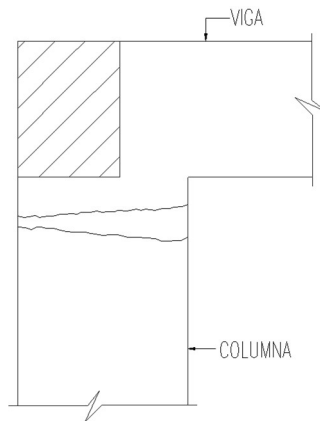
Fisuras en cabeza de columna segundo piso (archivo propio)
